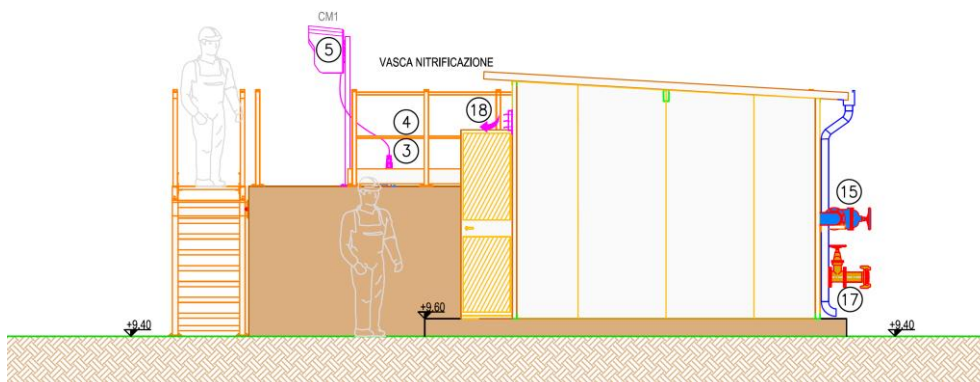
Prospetto nord-est del nuovo impianto di depurazione
